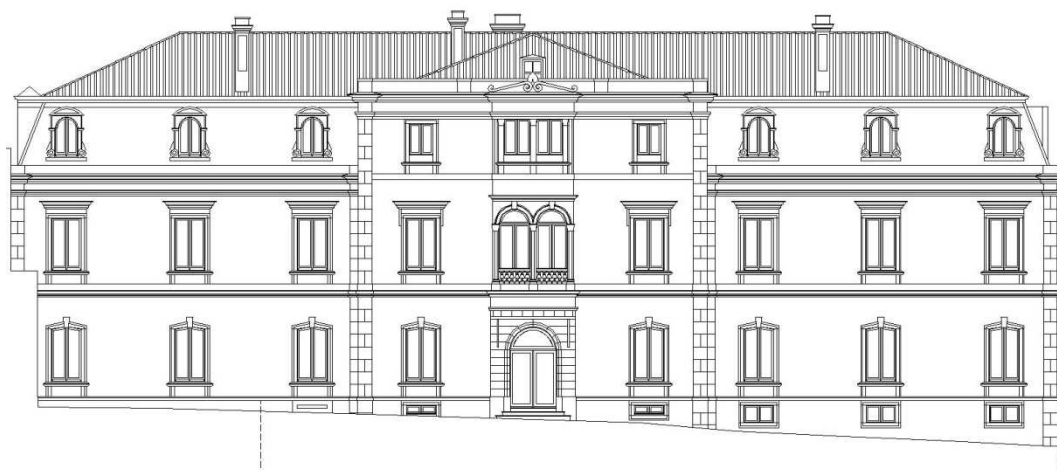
Fachada principal retirada do levantamento arquitetónico (TOPOMETRIA, 1998).
